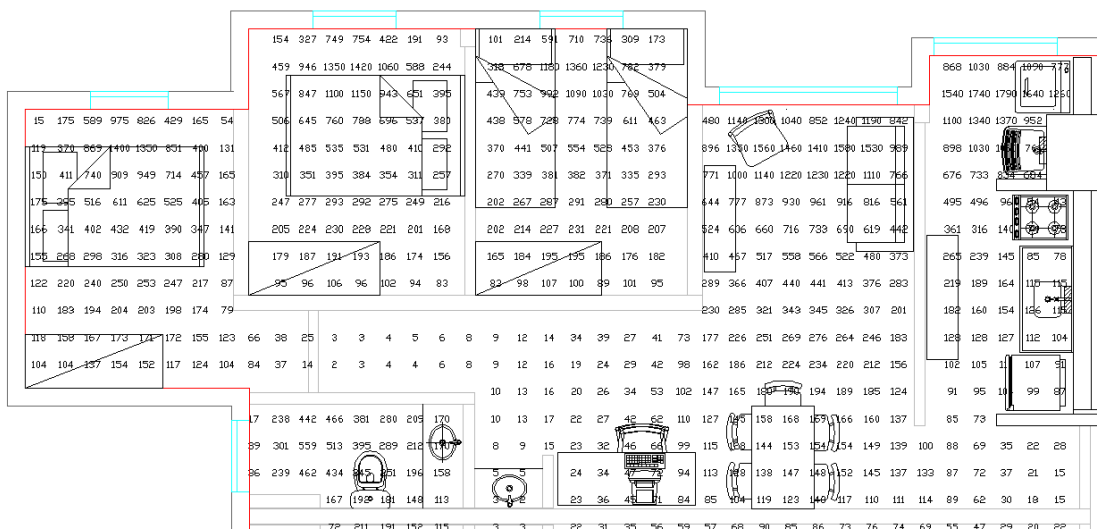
Distribuição da iluminância ponto a ponto no pavimento tipo (em lux).
